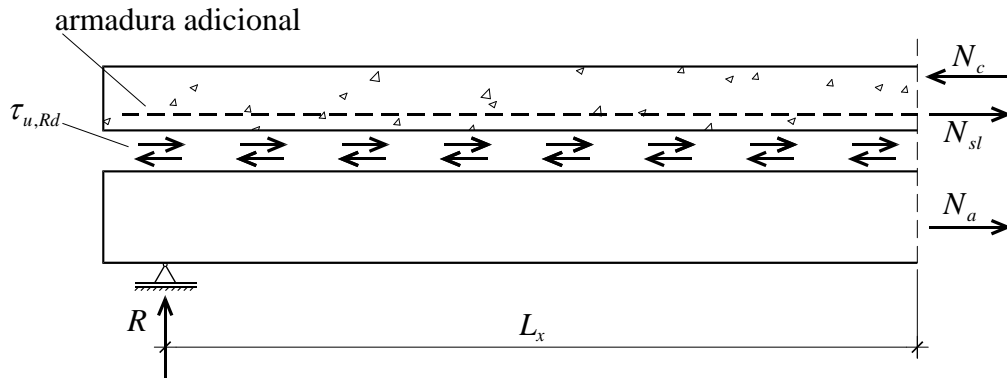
Forças atuantes num segmento de laje mista com armadura adicional.
